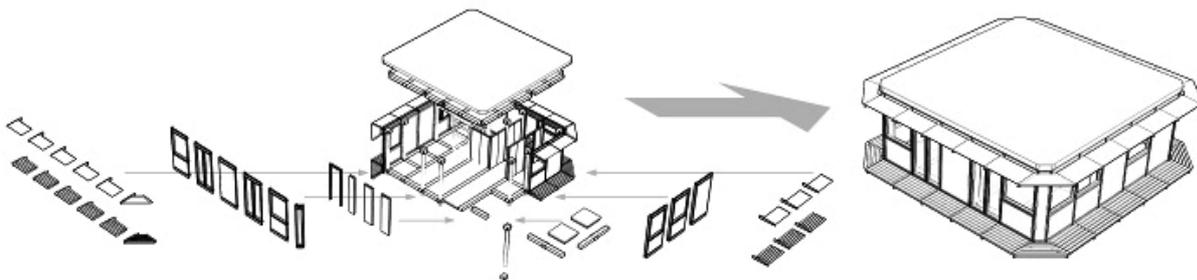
Sistema de pré-fabricação da empresa LUKASLANG [9]
